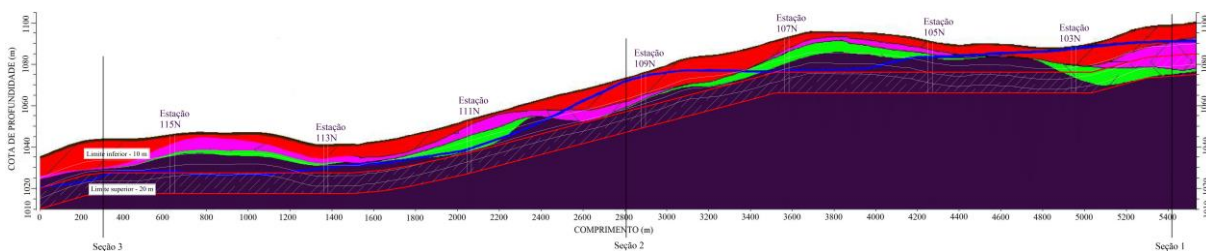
Localização das seções 1, 2 e 3 ao longo do traçado proposto.
